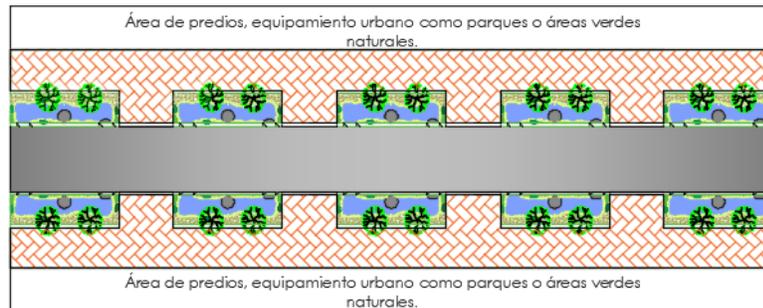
Ejemplo de emplazamiento de Jardín de lluvia y Pavimento permeable en corredor verde.
